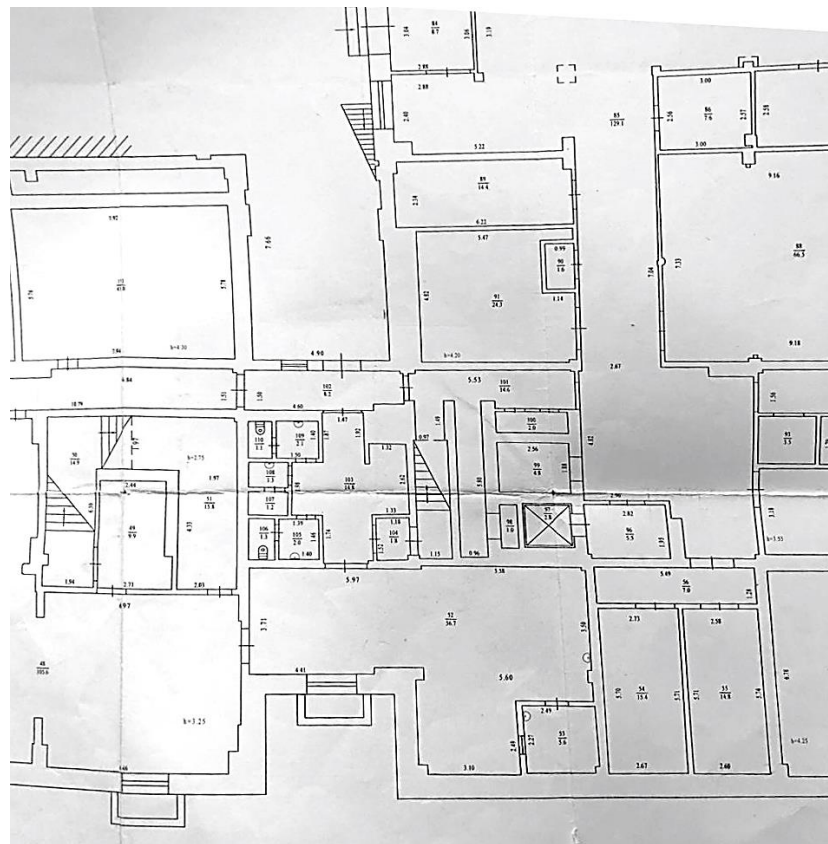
Фрагмент плану цокольного поверху будівлі учбового корпусу літ. «А-2-6-8».
